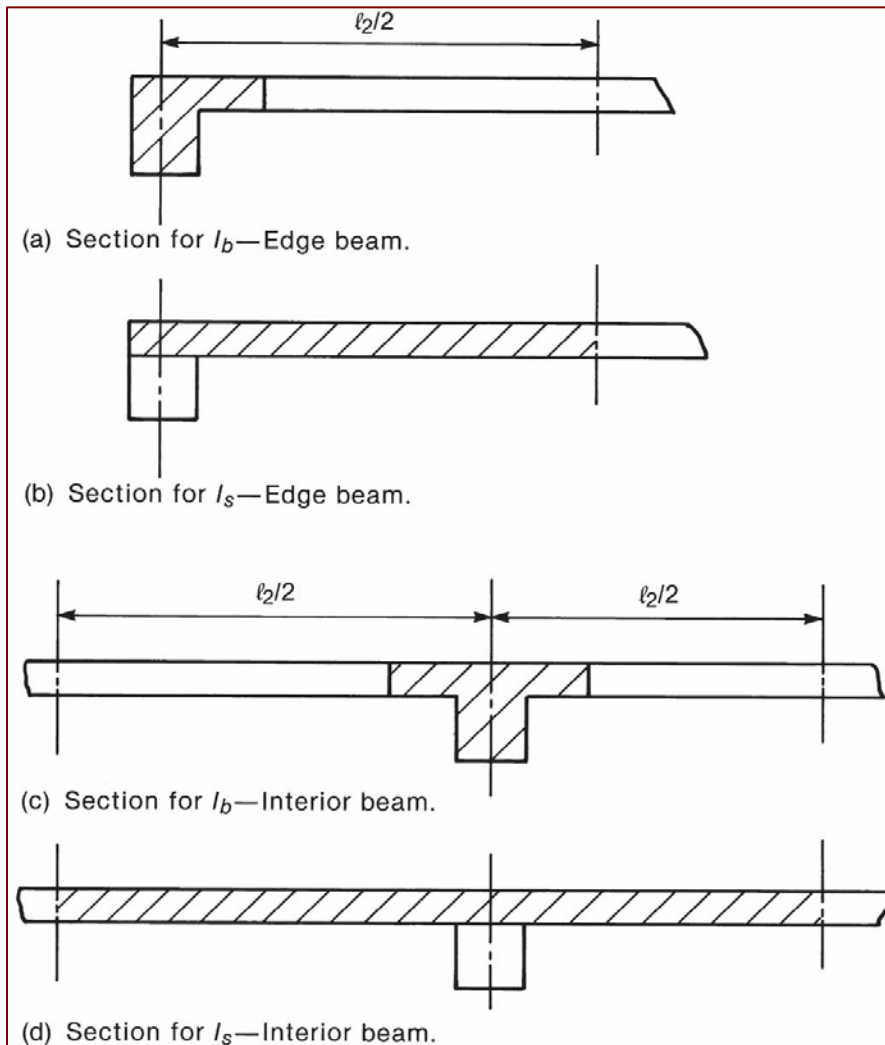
Secciones de viga y de losa para el cálculo de α_f .
